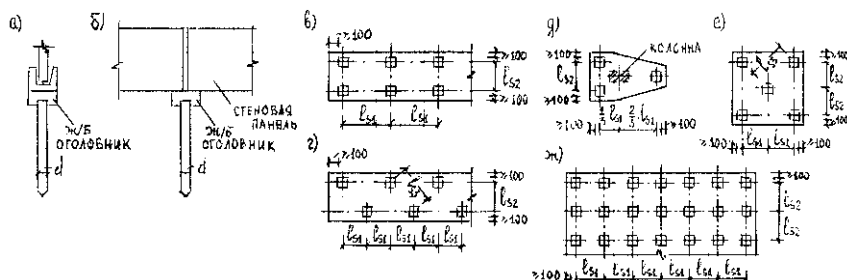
Виды свайных фундаментов: а, б — одиночные сваи, в, г — ленточные свайные фундаменты, д, е — свайные кусты, ж — сплошное свайное поле
